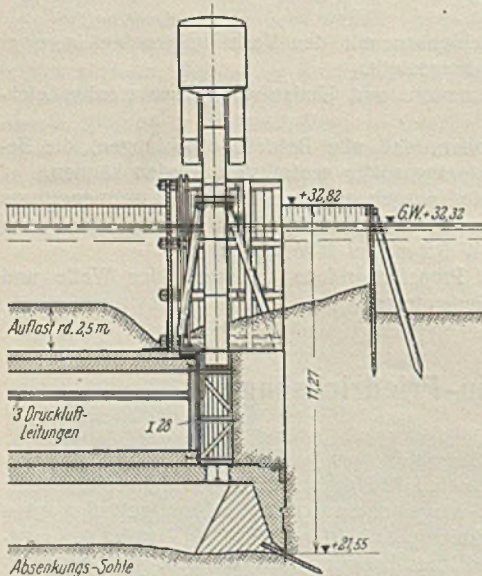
Senkkasten 1 fertig abgesenkt. Druckluftbeton eingebracht.
